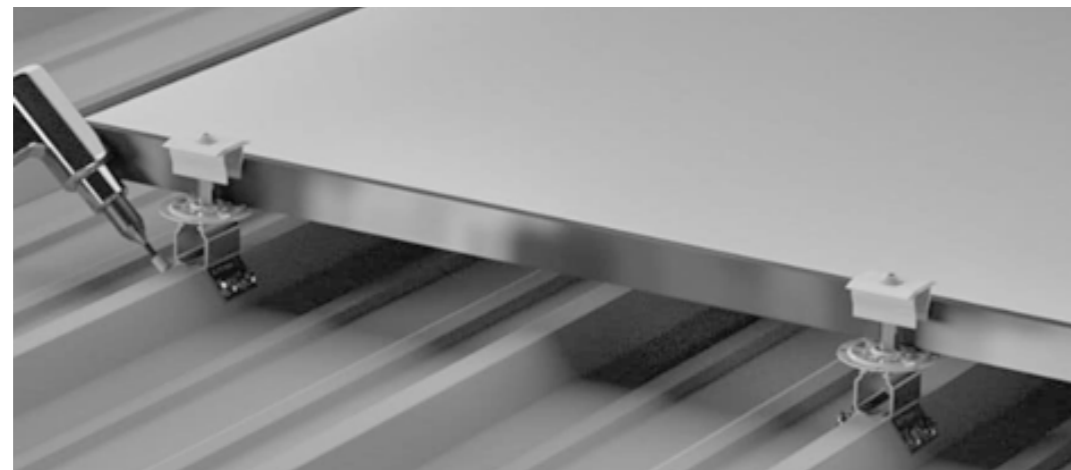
Sistema de anclaje seleccionado. Broches para junta adyacente.
